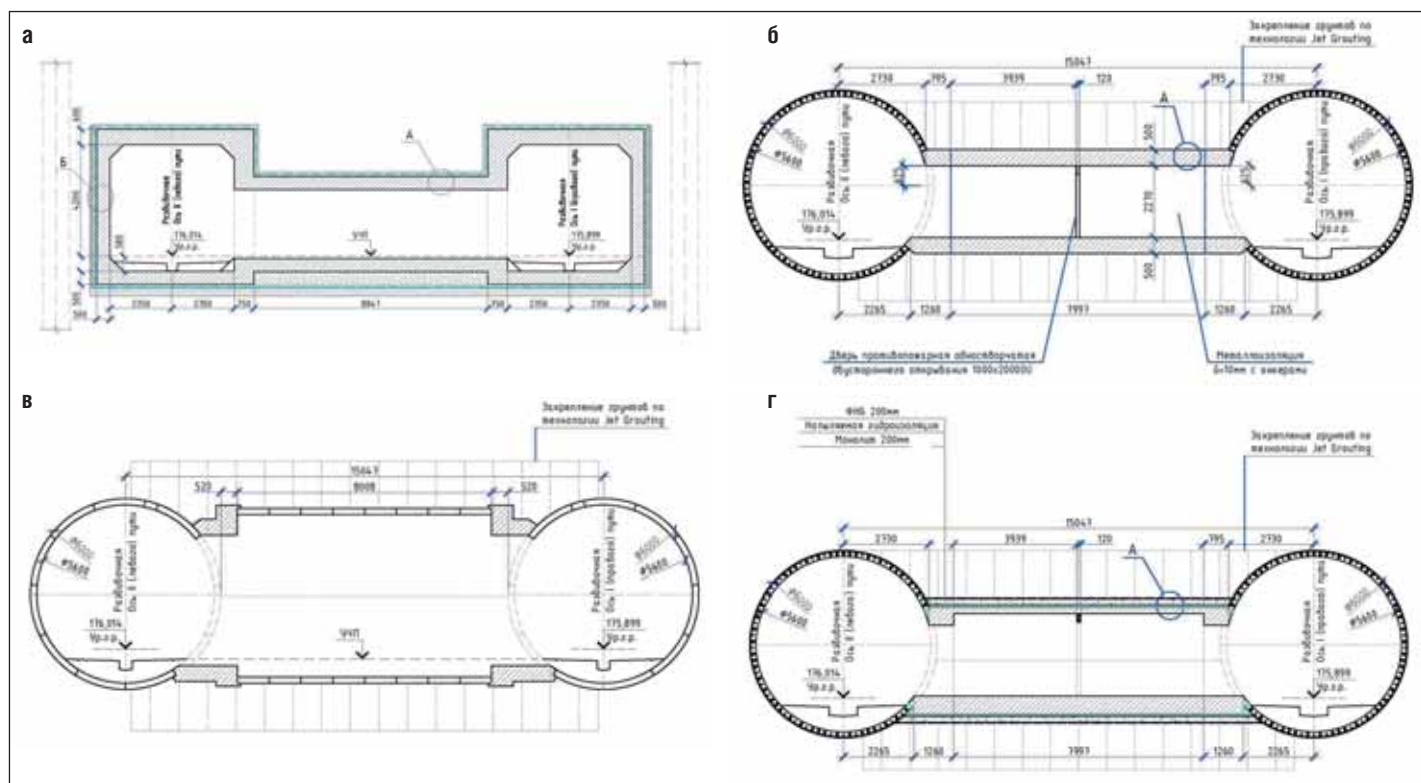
Конструкция сбойки: а – открытым способом; б – с временной арочной крепью и металлоизоляцией; в – со сборной чугунной обделкой; г – с набрызг-бетоном
